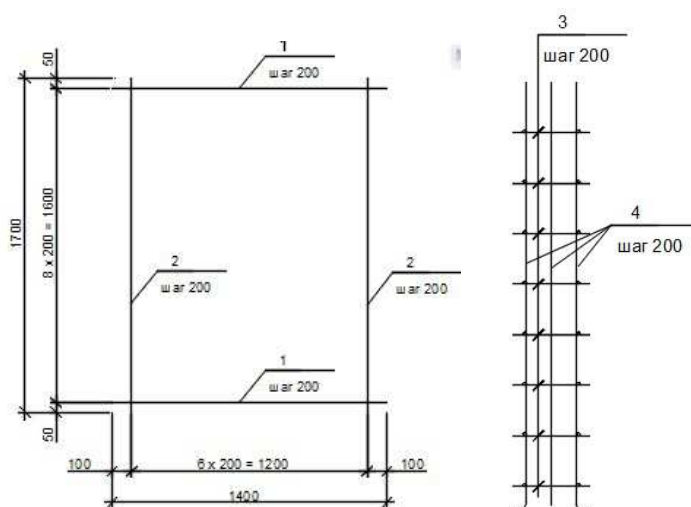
Сетка С-1 - для армирования подошвы ; КР2 – для армирования подколоннека.
